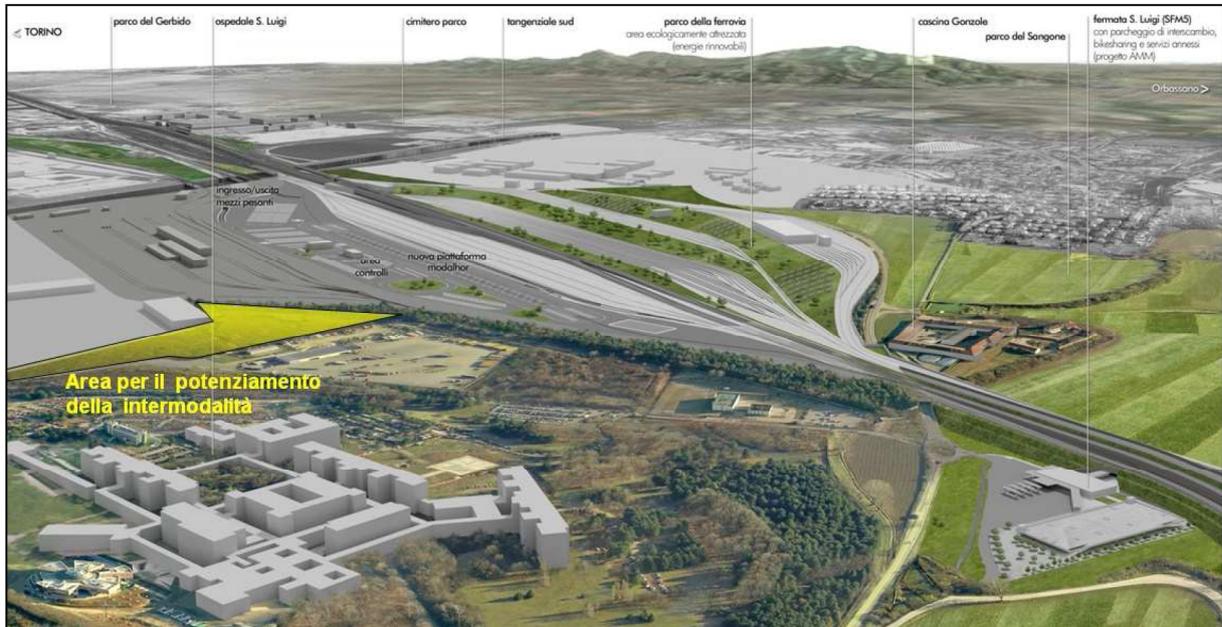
Lo scalo di Orbassano: ricostruzione prospettica con vista da nord-ovest
